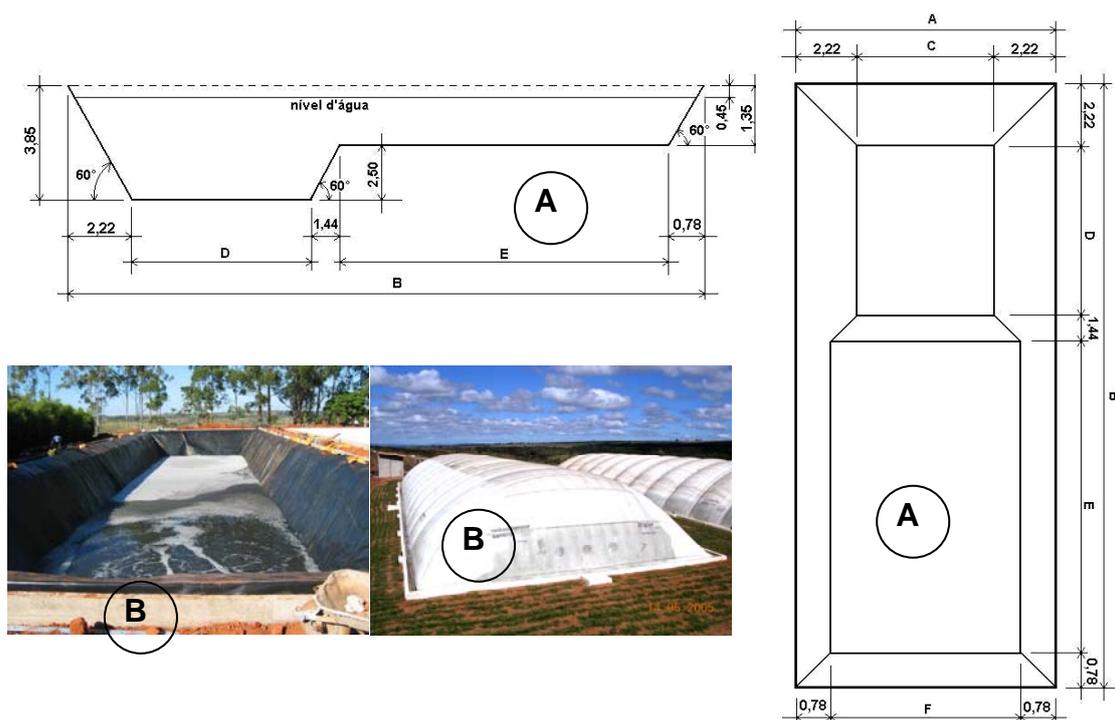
Modelo de biodigestor adotado pela empresa AgCert, em planta baixa (A) e construído (B).
